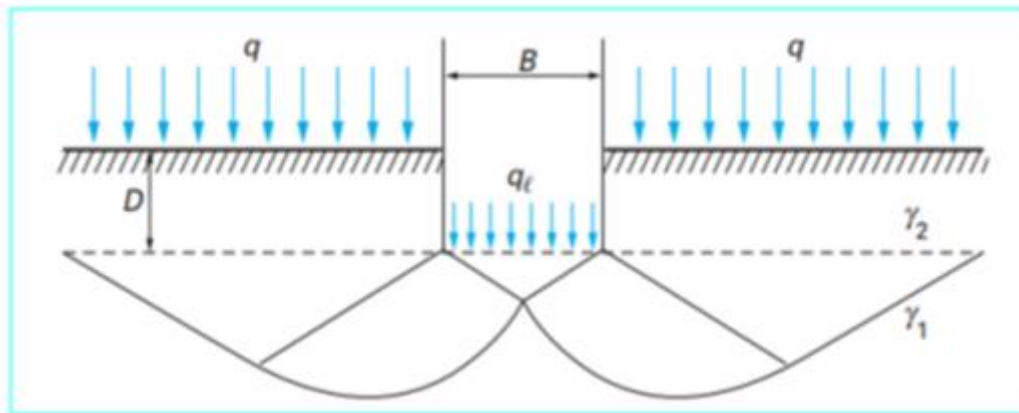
Schéma de rupture d'une fondation superficielle. [6]
